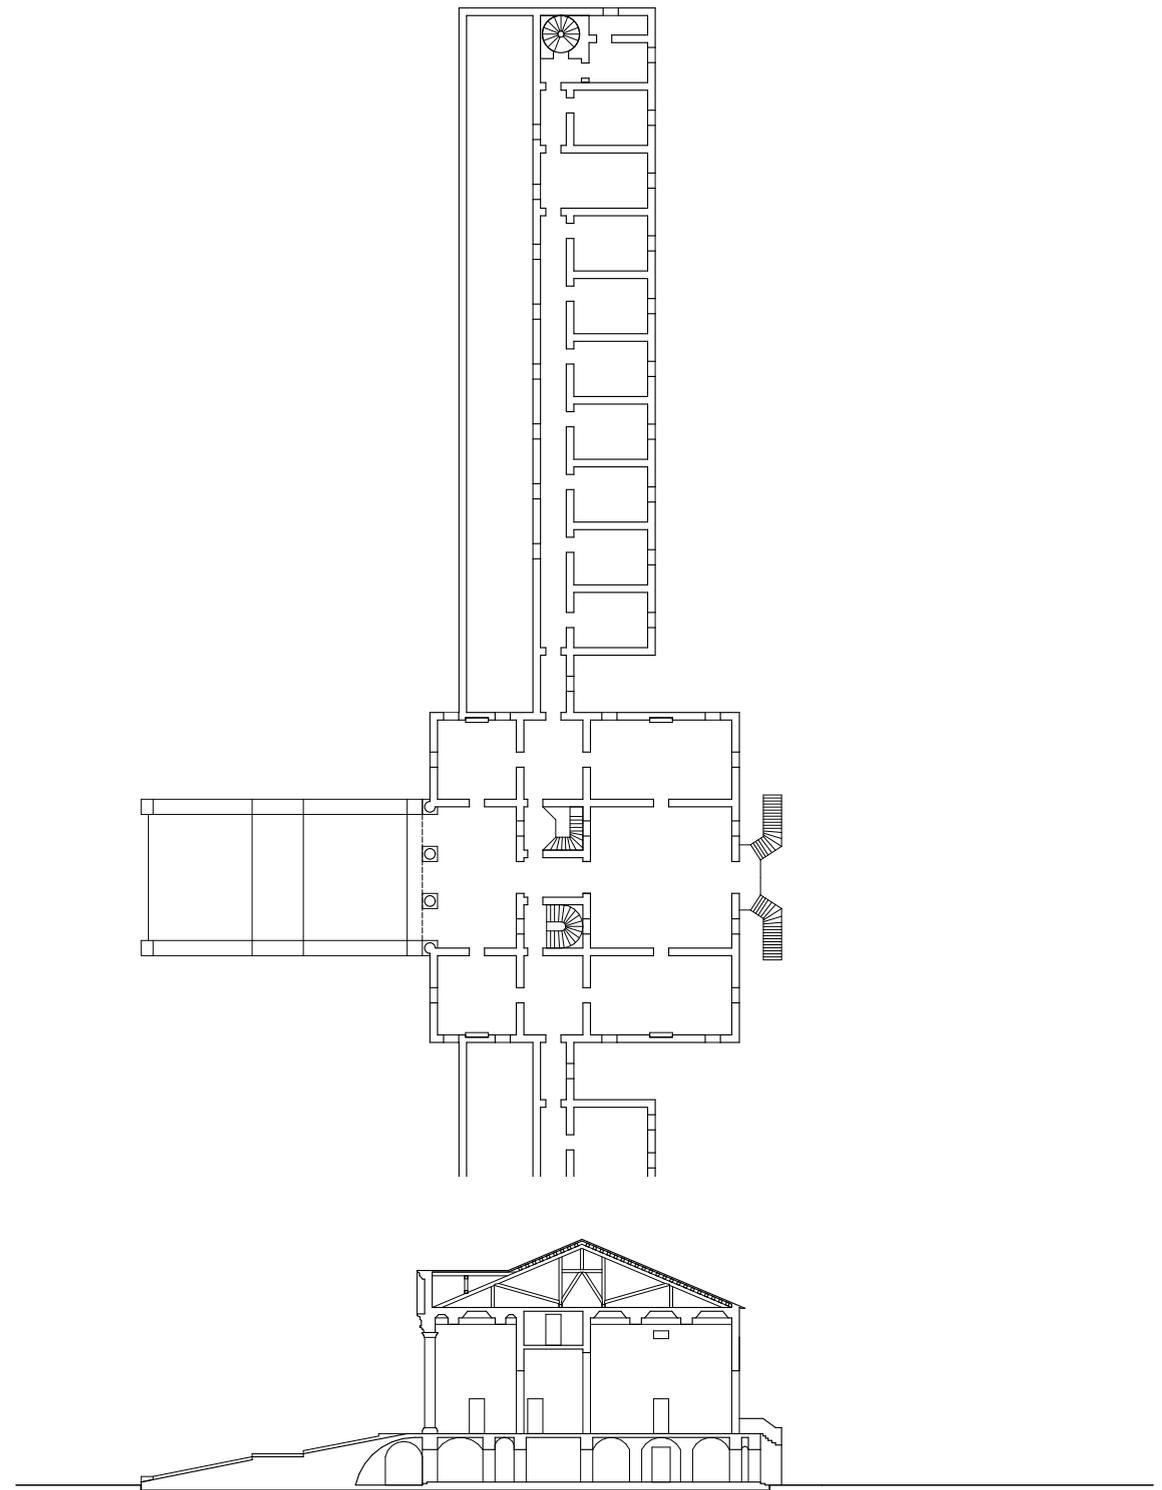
| Villa Emo, Grundriss und Schnitt, M 1:500
